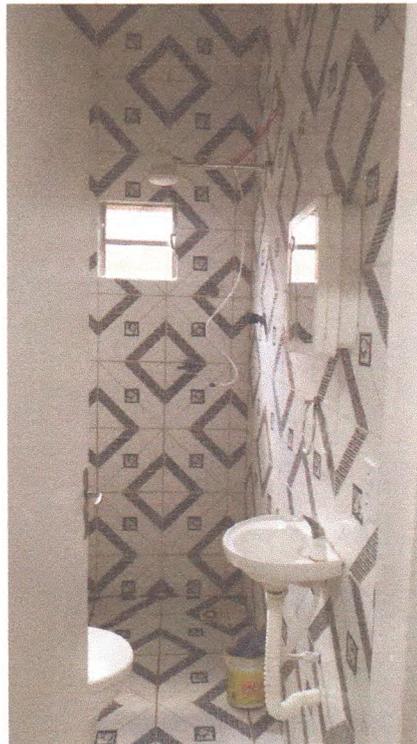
Revestimento cerâmico do banheiro do pavimento térreo
